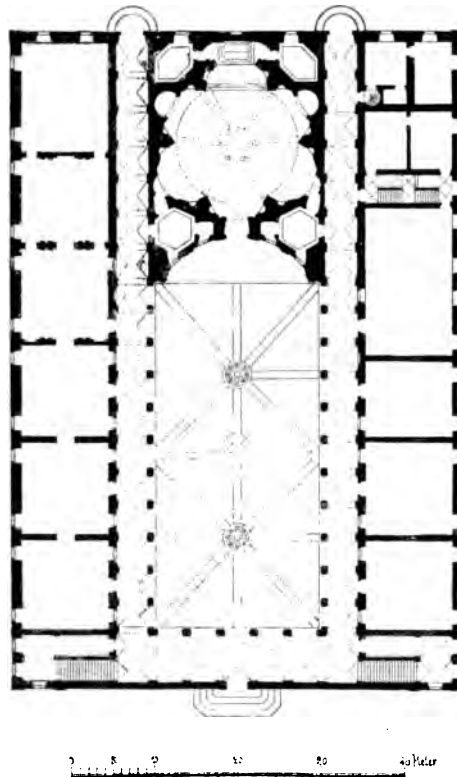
Sapienza zu Rom. Grundriss.
